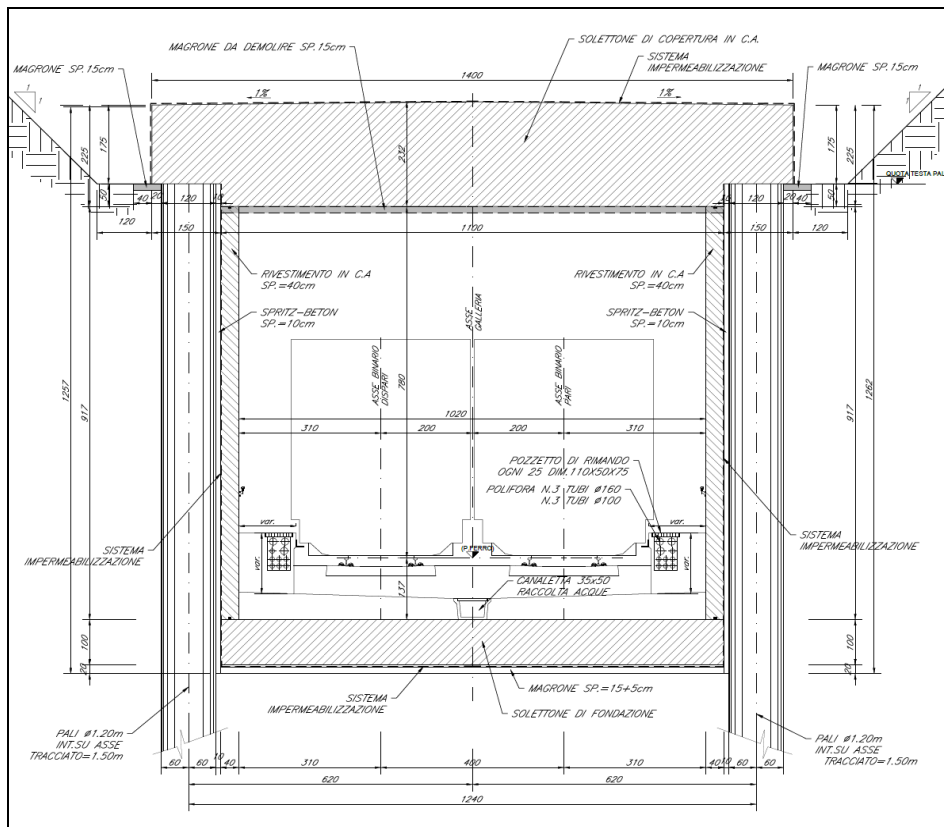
Galleria Teleso - Sezione Trasversale tipo C, C1, C3, C4 (Rif.: [3])
